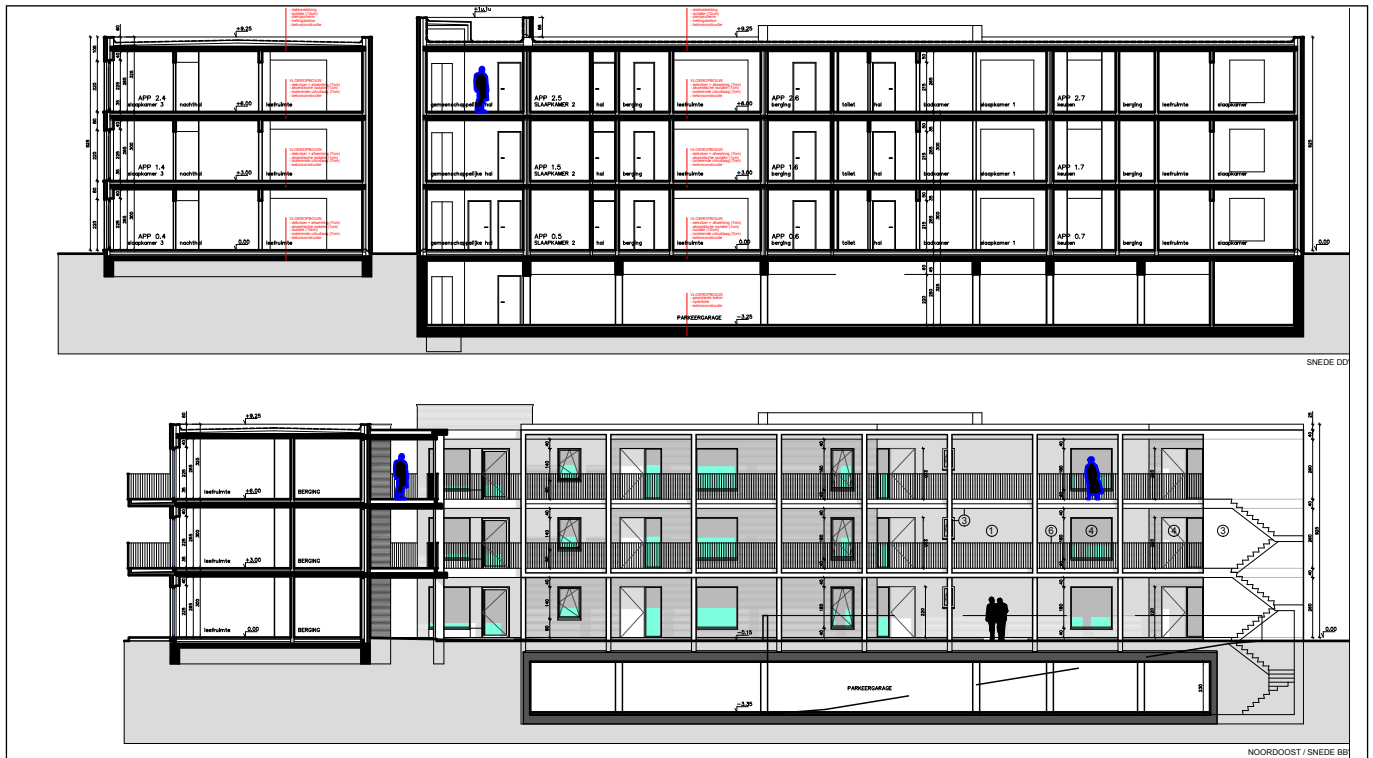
Een overzicht van de geplande bouwwerken op het projectgebied (© Avapartners Architects & Planners)
